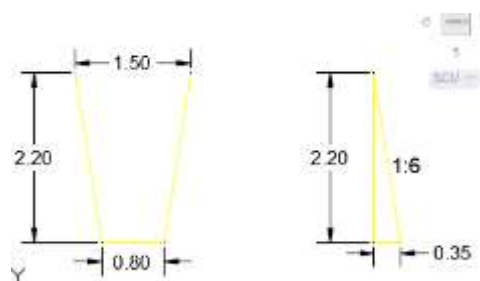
Vista Frontal de excavación tramos 3-4 y 4-5
